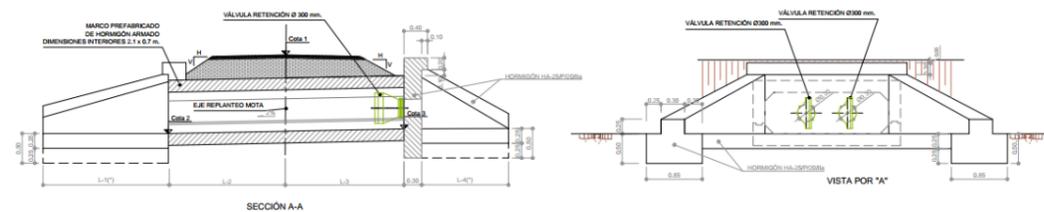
Secciones tipo. Obra de drenaje con dos válvulas de retención
